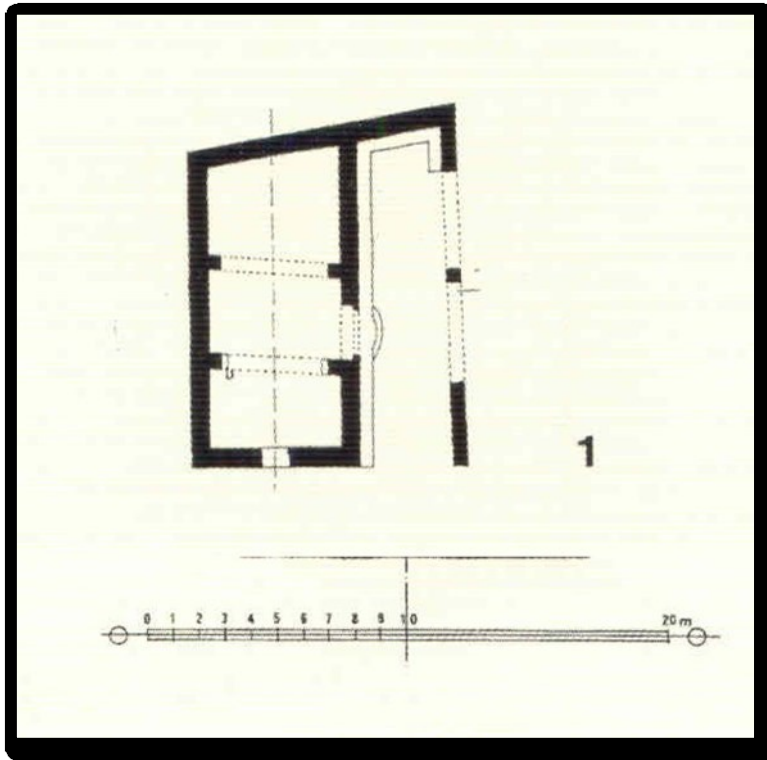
Planta de la ermita según Arturo Zaragoza.
